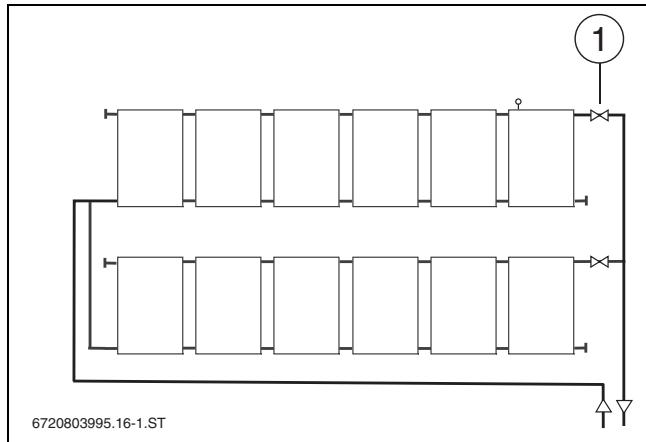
Collegamento su lati opposti di un collegamento in parallelo
